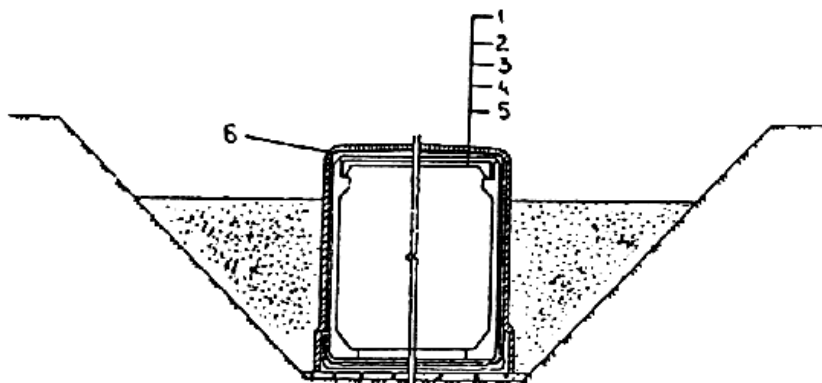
Защита гидроизоляции перекрытия:
